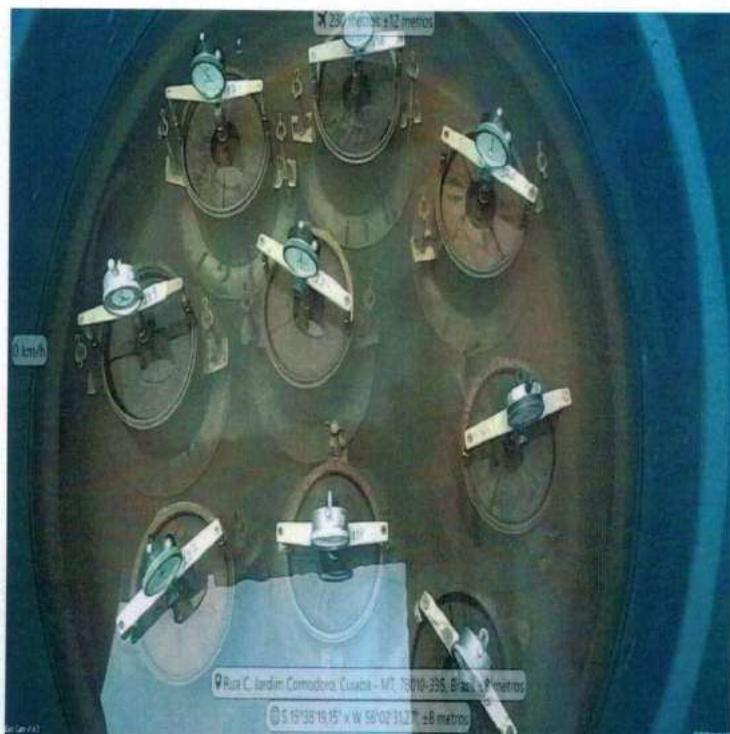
ENSAIO DE EXPANSÃO E IMERSÃO PARA CBR.
